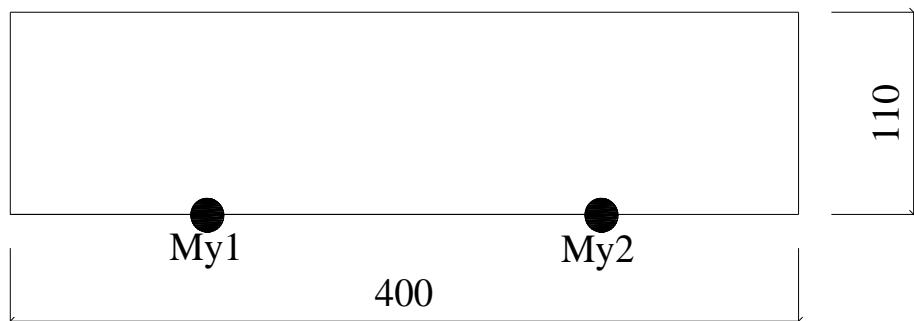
Arah pembebanan pondasi tiang bor pada poer (2 tiang)
